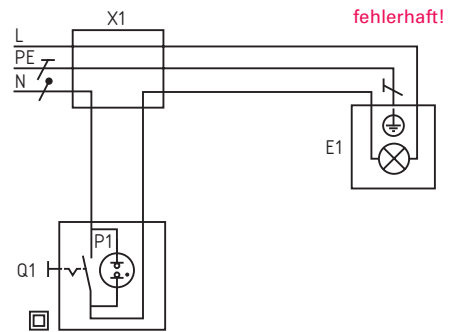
Ausschaltung mit beleuchtetem Ausschalter
